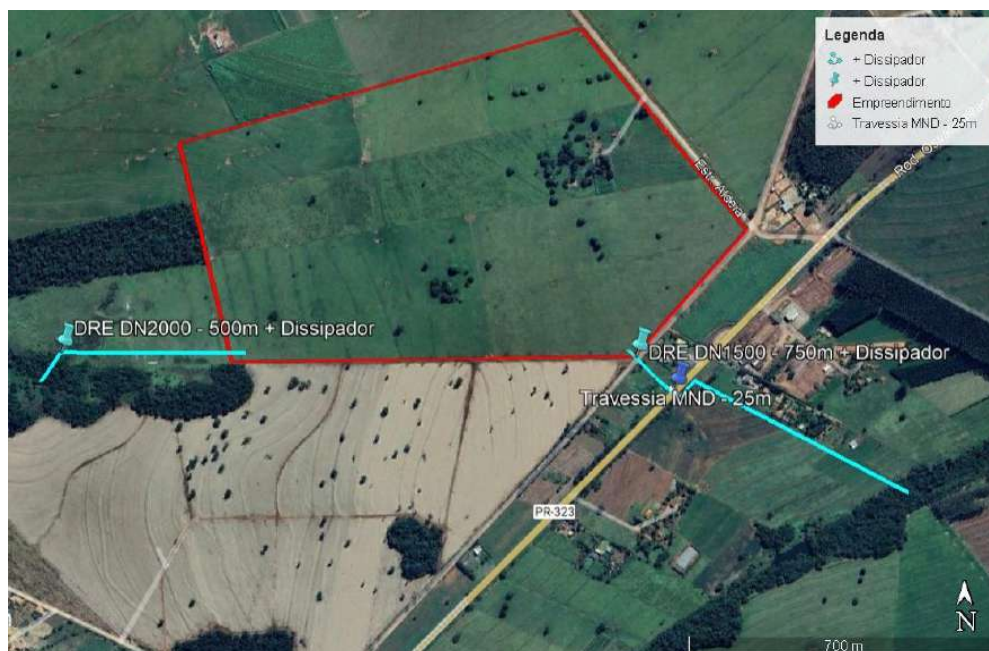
Croqui do sistema de drenagem previsto pelo empreendimento. Fonte: Empreendedor.
